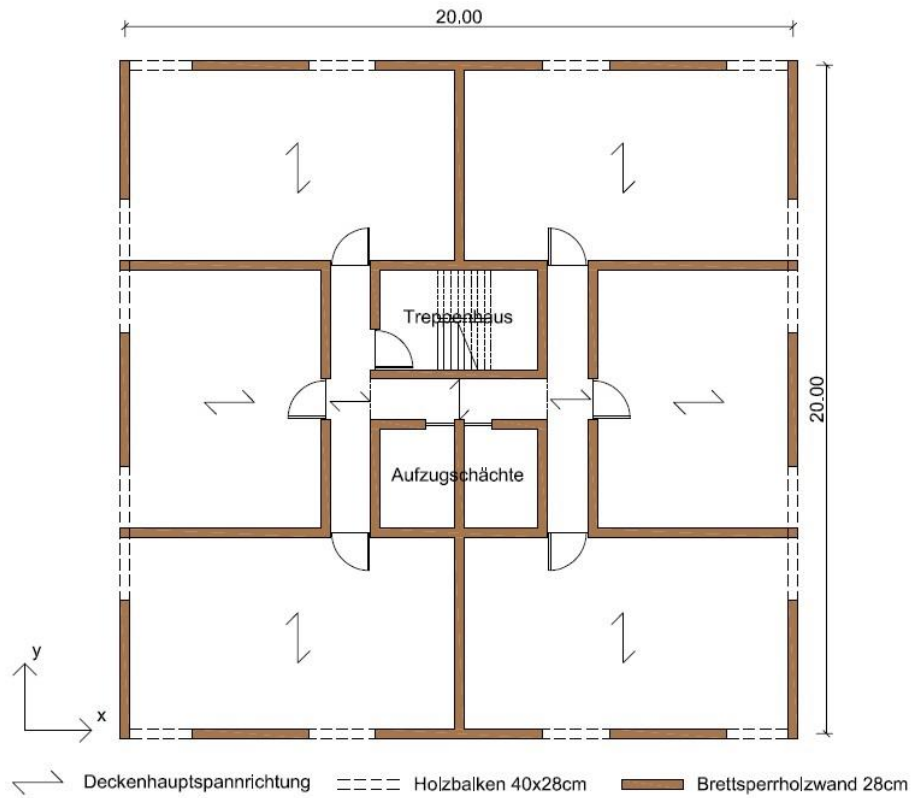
Grundriss der reinen Brettsperrholzkonstruktion
